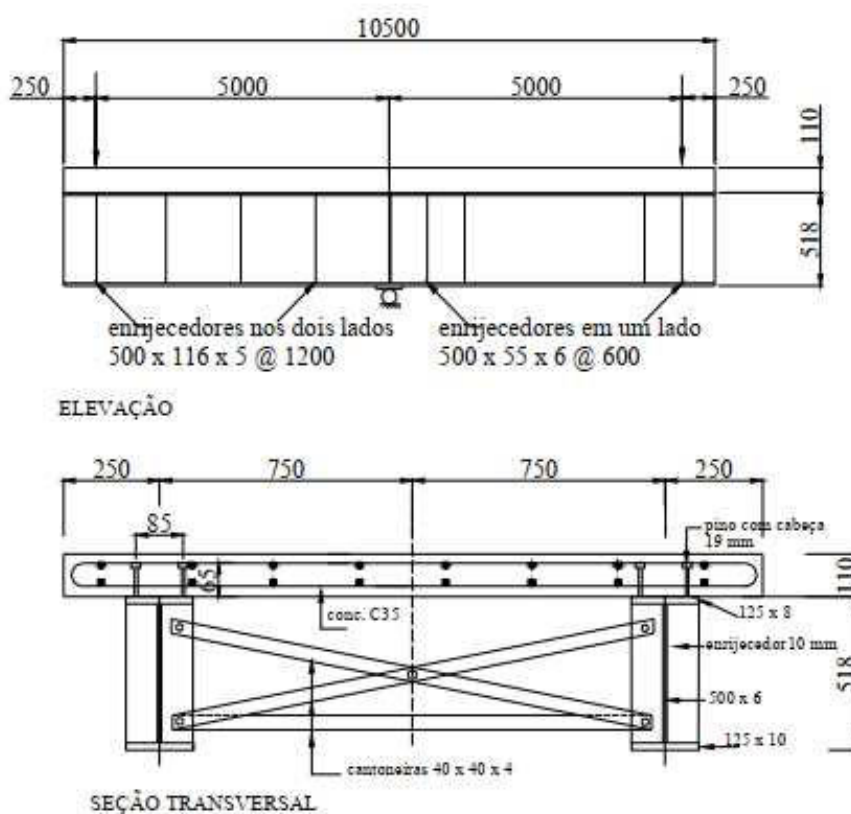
Geometria e seção transversal do modelo U5 (CALENZANI, 2008).
